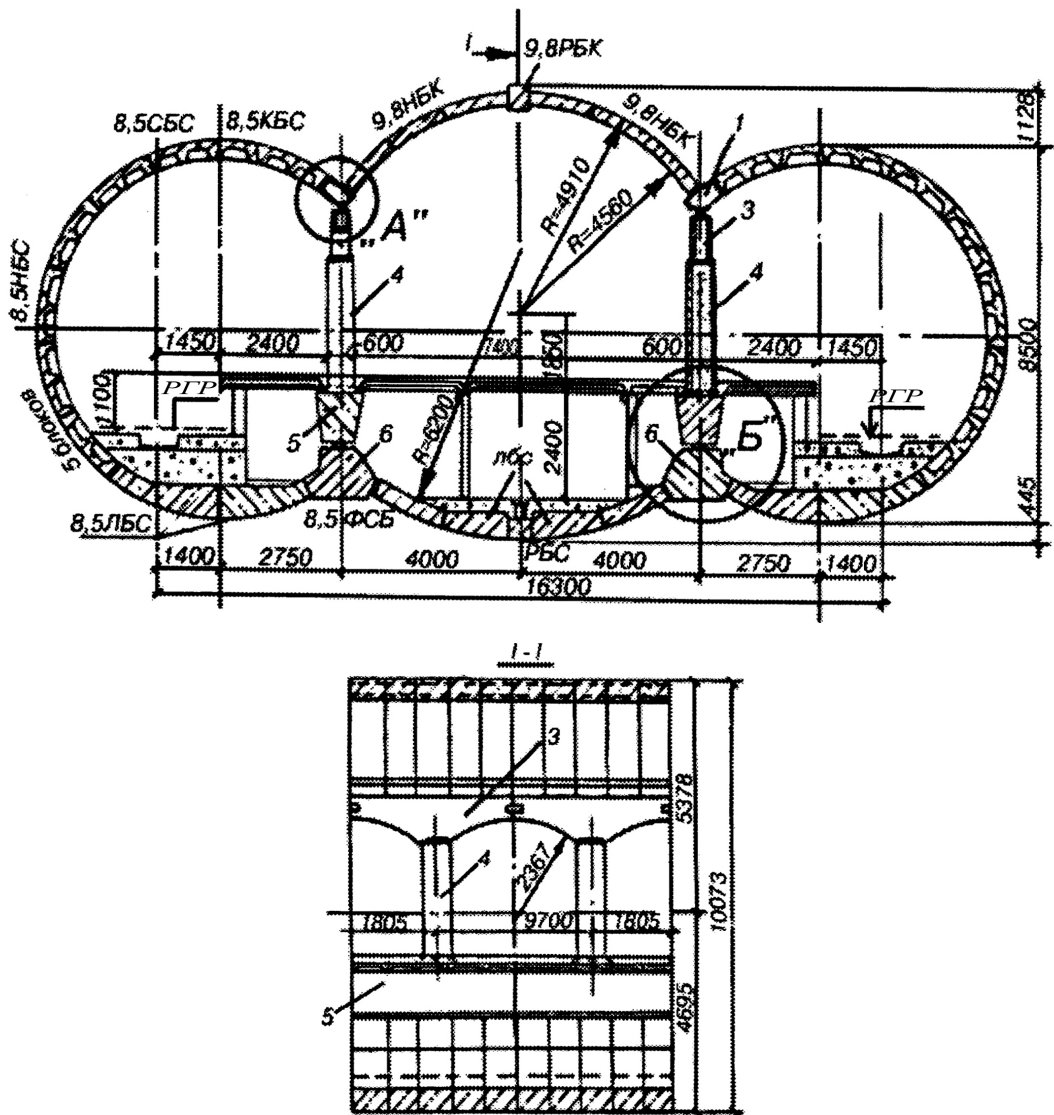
Конструкція з оправою із залізобетонних елементів та фундаментними блоками (вузол «А» – фасонний тубінг, вузол «Б» – кріплення нижнього прогону)
